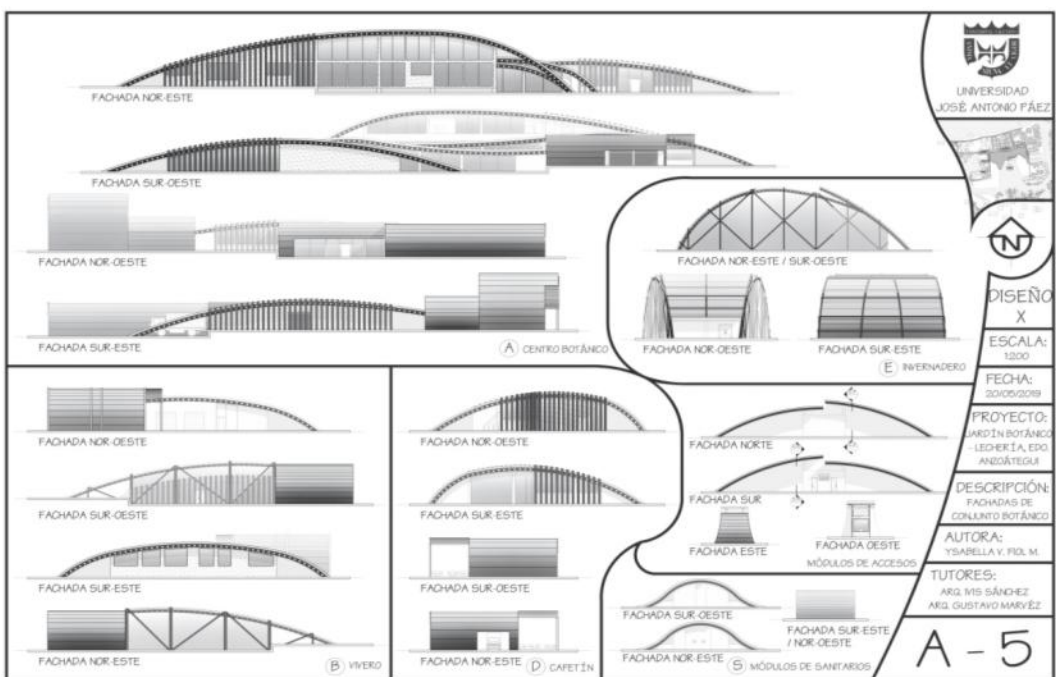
Plano A-5: Fachadas de las Edificaciones. Fuente: Propia
